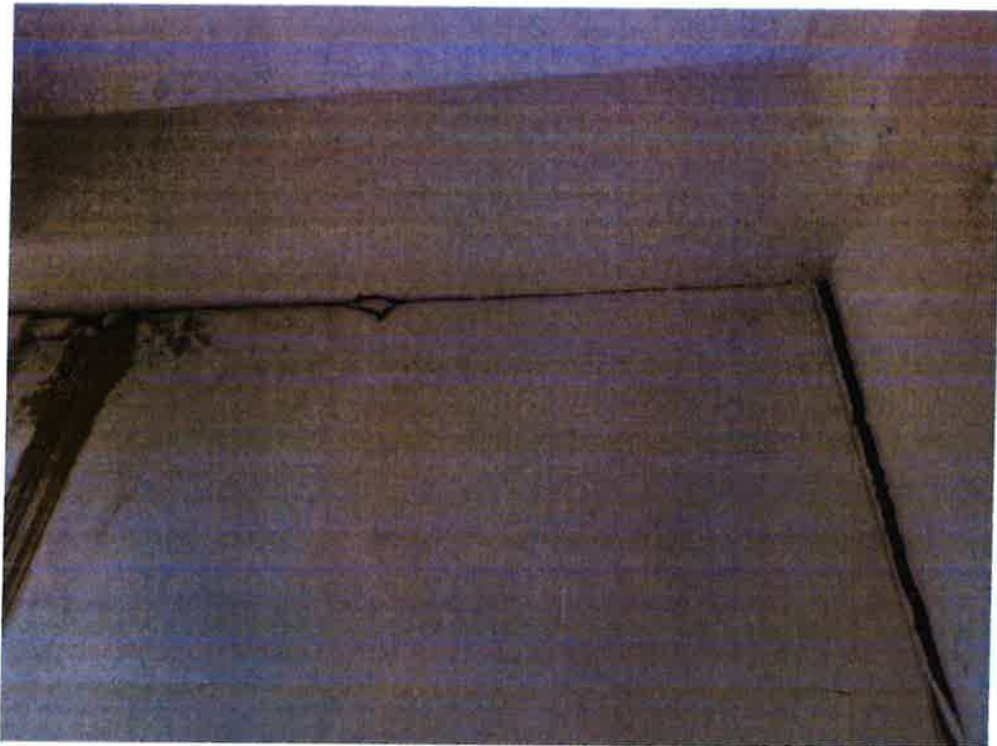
Junta de dilatación entre columna y muro agrietado.
